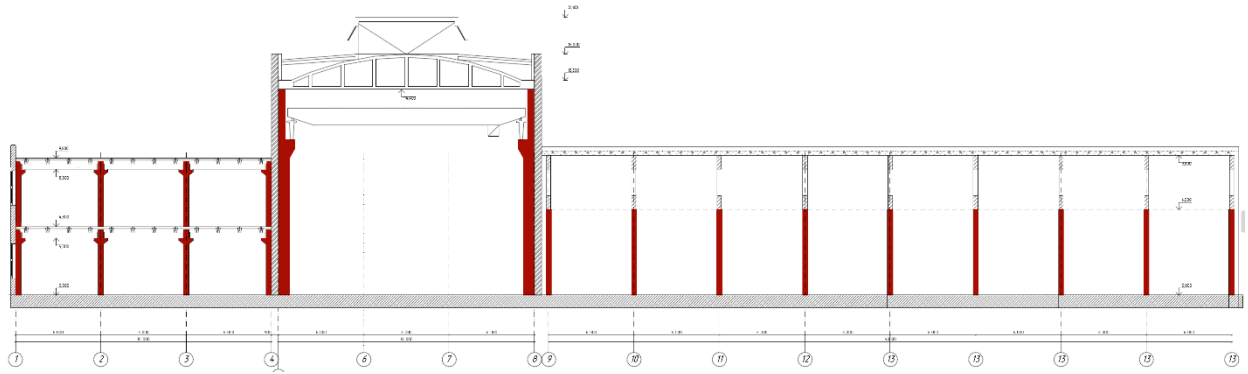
Висотна схема розташування конструкцій каркаса одноповерхової та багатоповерхової промислової будівлі.
